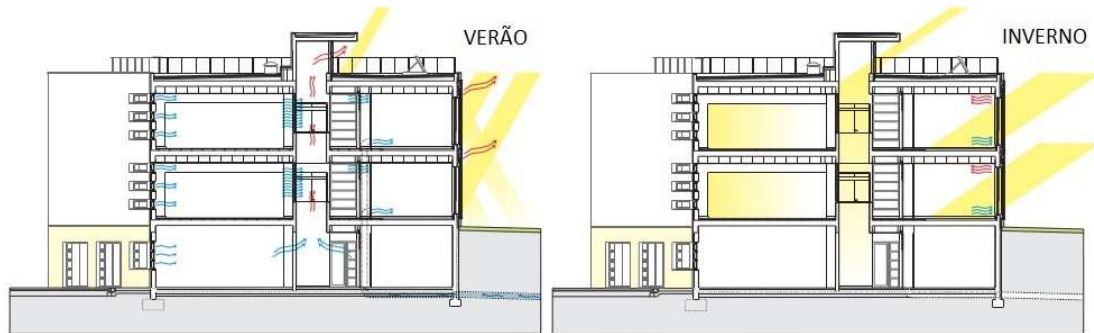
ILUMINAÇÃO NATURAL E VENTILAÇÃO.
